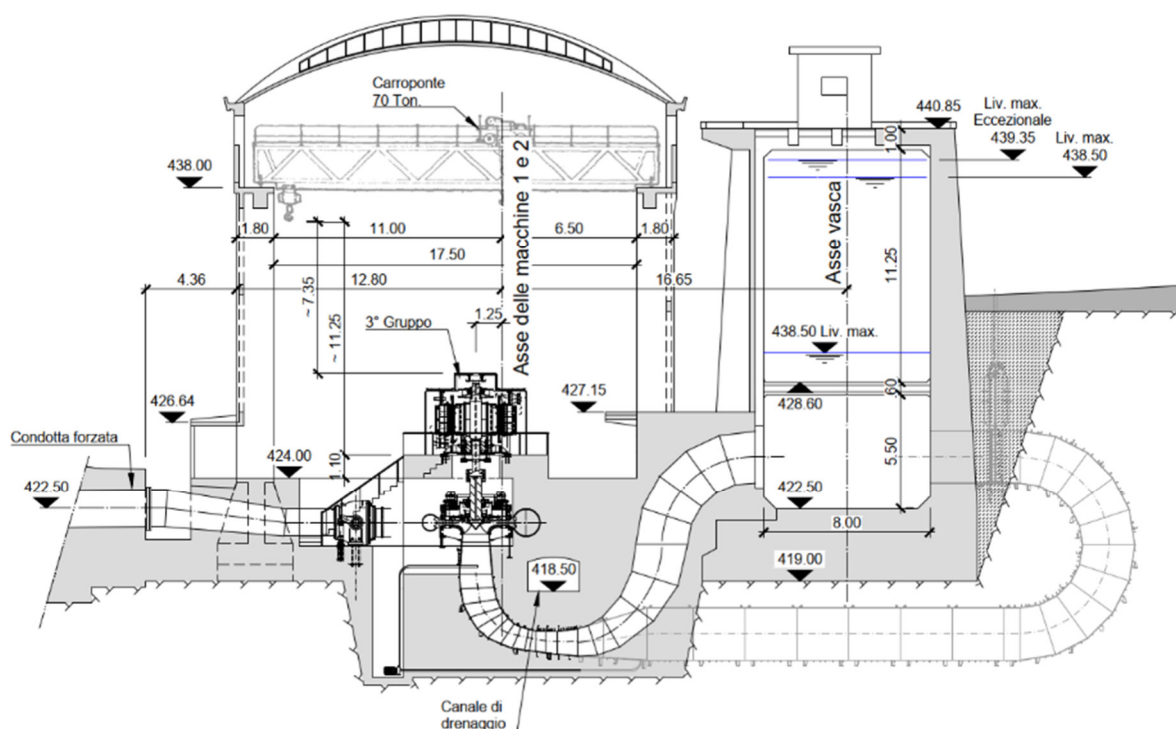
Posizionamento di progetto gruppo macchina 3 con due alternative di tracciato
